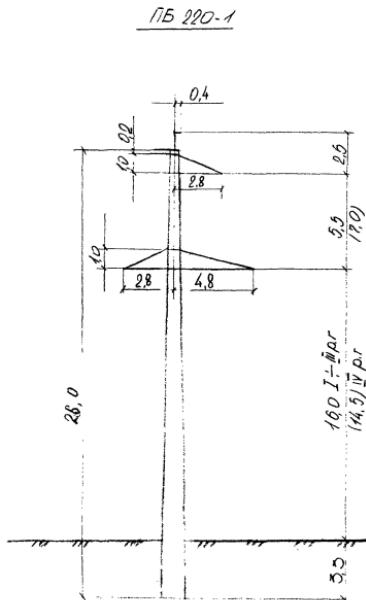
Одноцепные железобетонные опоры ПБ 220 кВ
